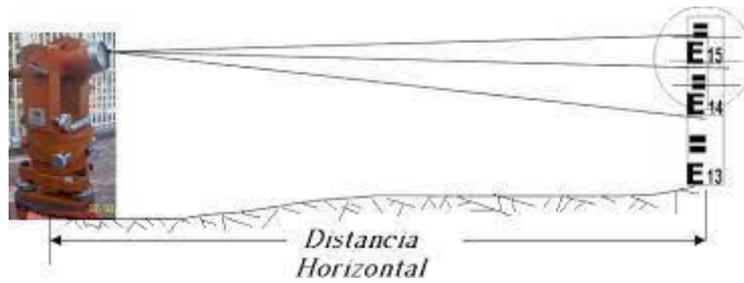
Instrumento para el levantamiento planimétrico mediante teodolito.
